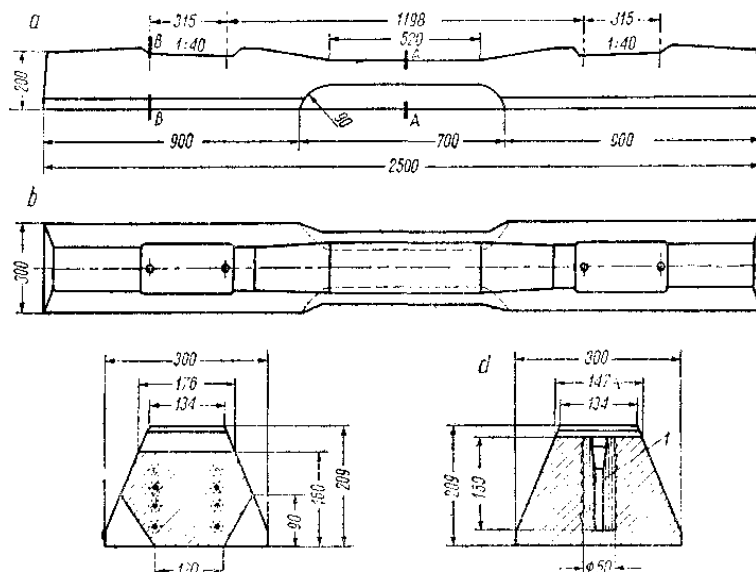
Podkład żelbetowy blokowy typu B1-3: a – widok z boku, b – widok z góry, c – przekrój A – A [1, s. 61]
